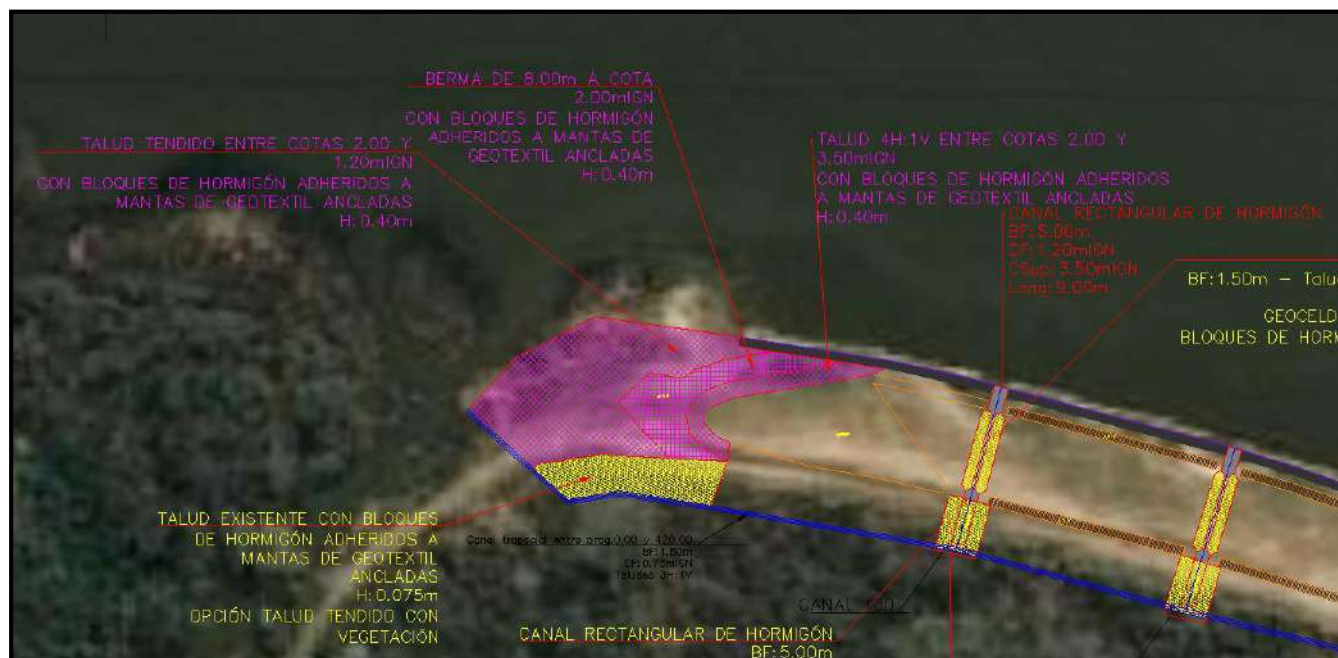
Ubicación en planta de la protección contra oleaje (rosa) – altura de bloques 0.40 m.
